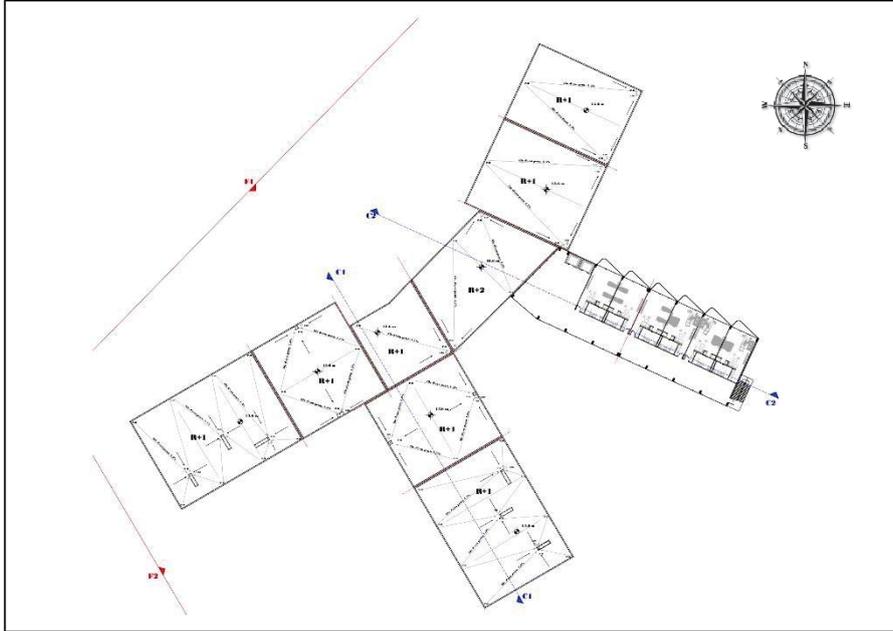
plan niveau 2/3/4/5/6 source (l'auteur)
